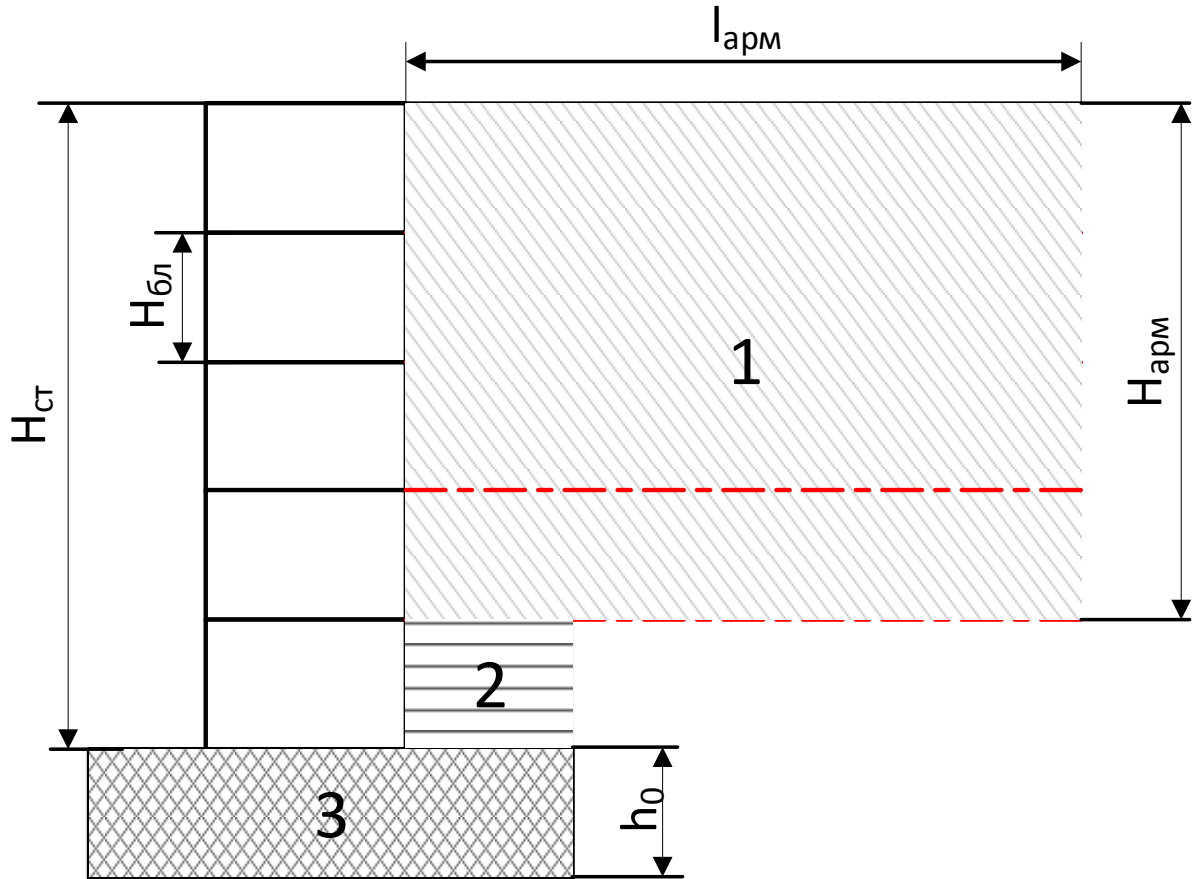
Расчетная схема армогрунтовой конструкции
